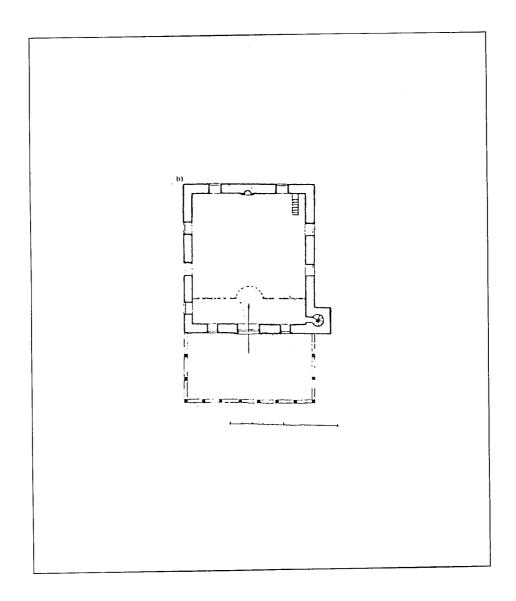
مسقط أفقي لمسجد الفاتح في كستنديل (عن : ايفردى) .
